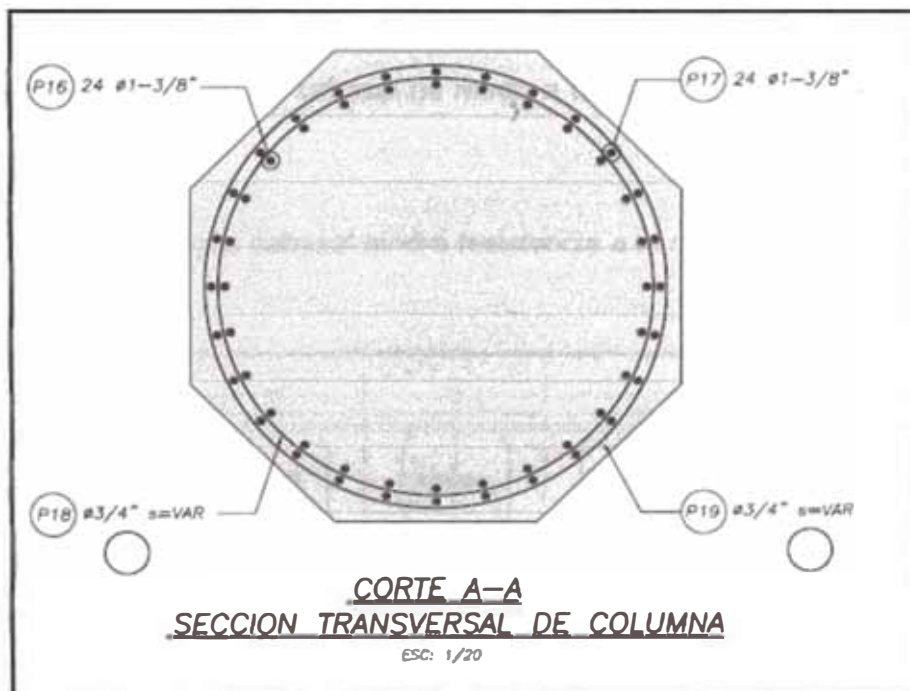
Sección Transversal de las columnas centrales S50 Y S51
